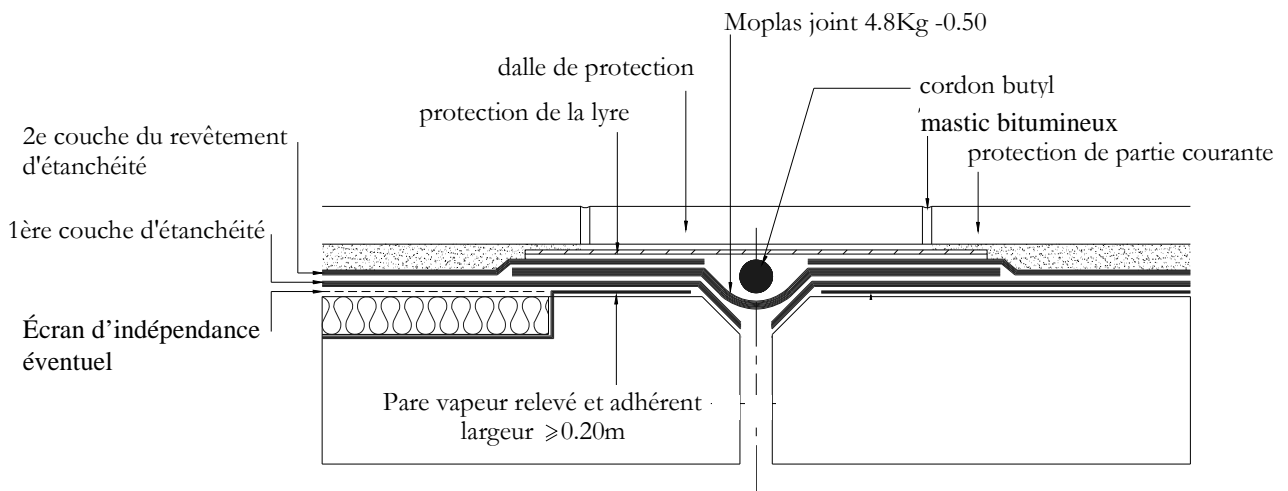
Butées en isolant pour terrasses inaccessibles ou accessibles aux piétons et au séjour
